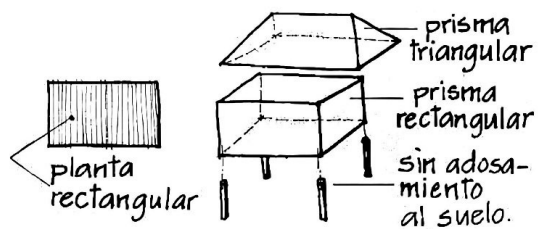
y Figura 70: Isometrías y planimetrías de techo y distribución interior de una vivienda
